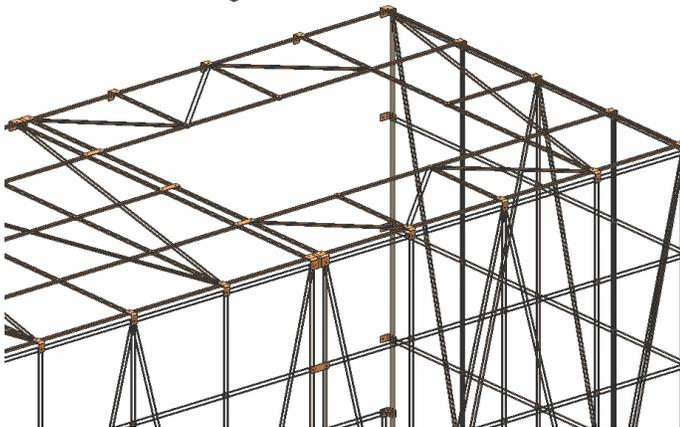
Details der Modulbauweise mit Stützstrukturen (1)
